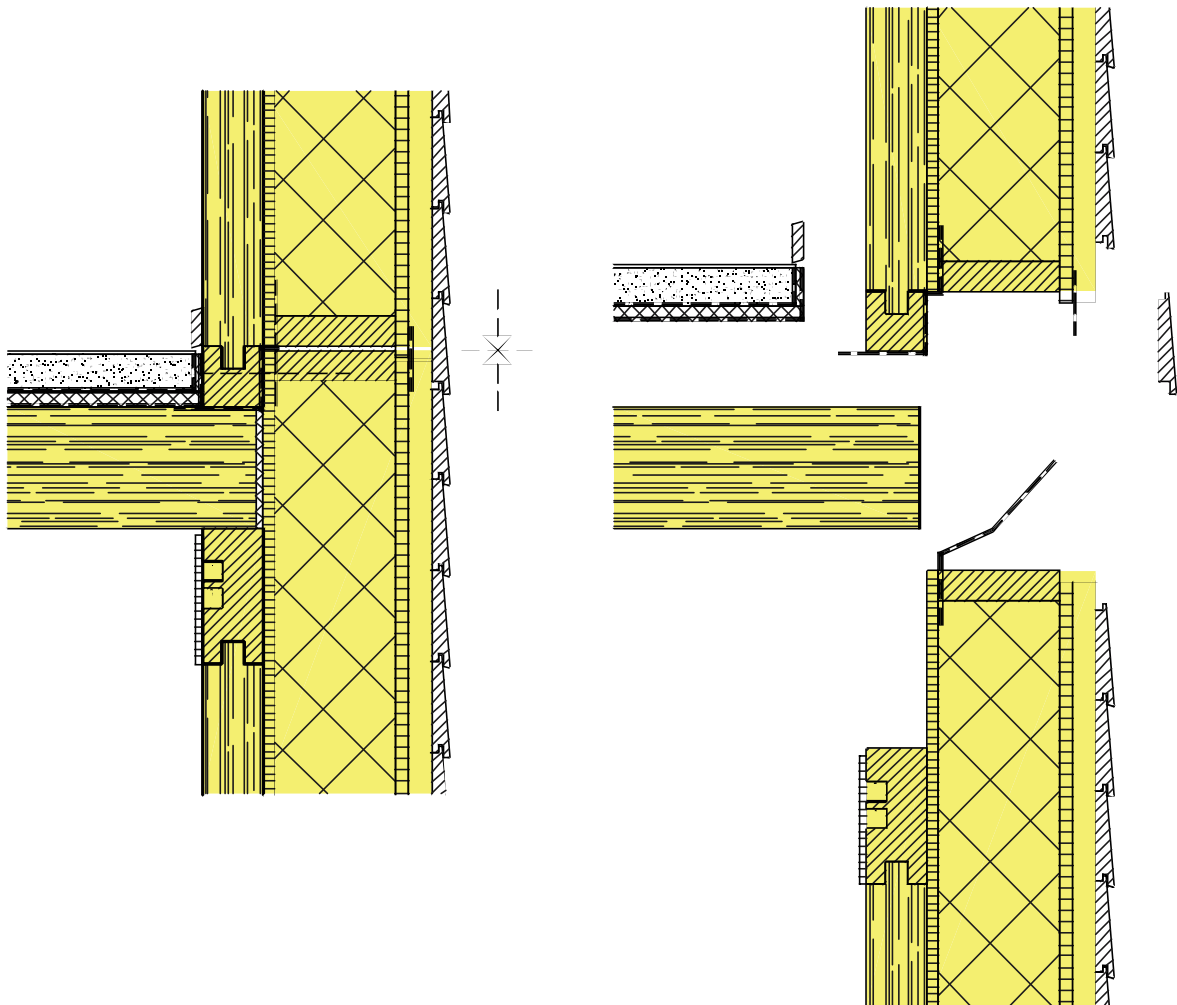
Detail Fügung Außenwände-Decke, M 1:10
